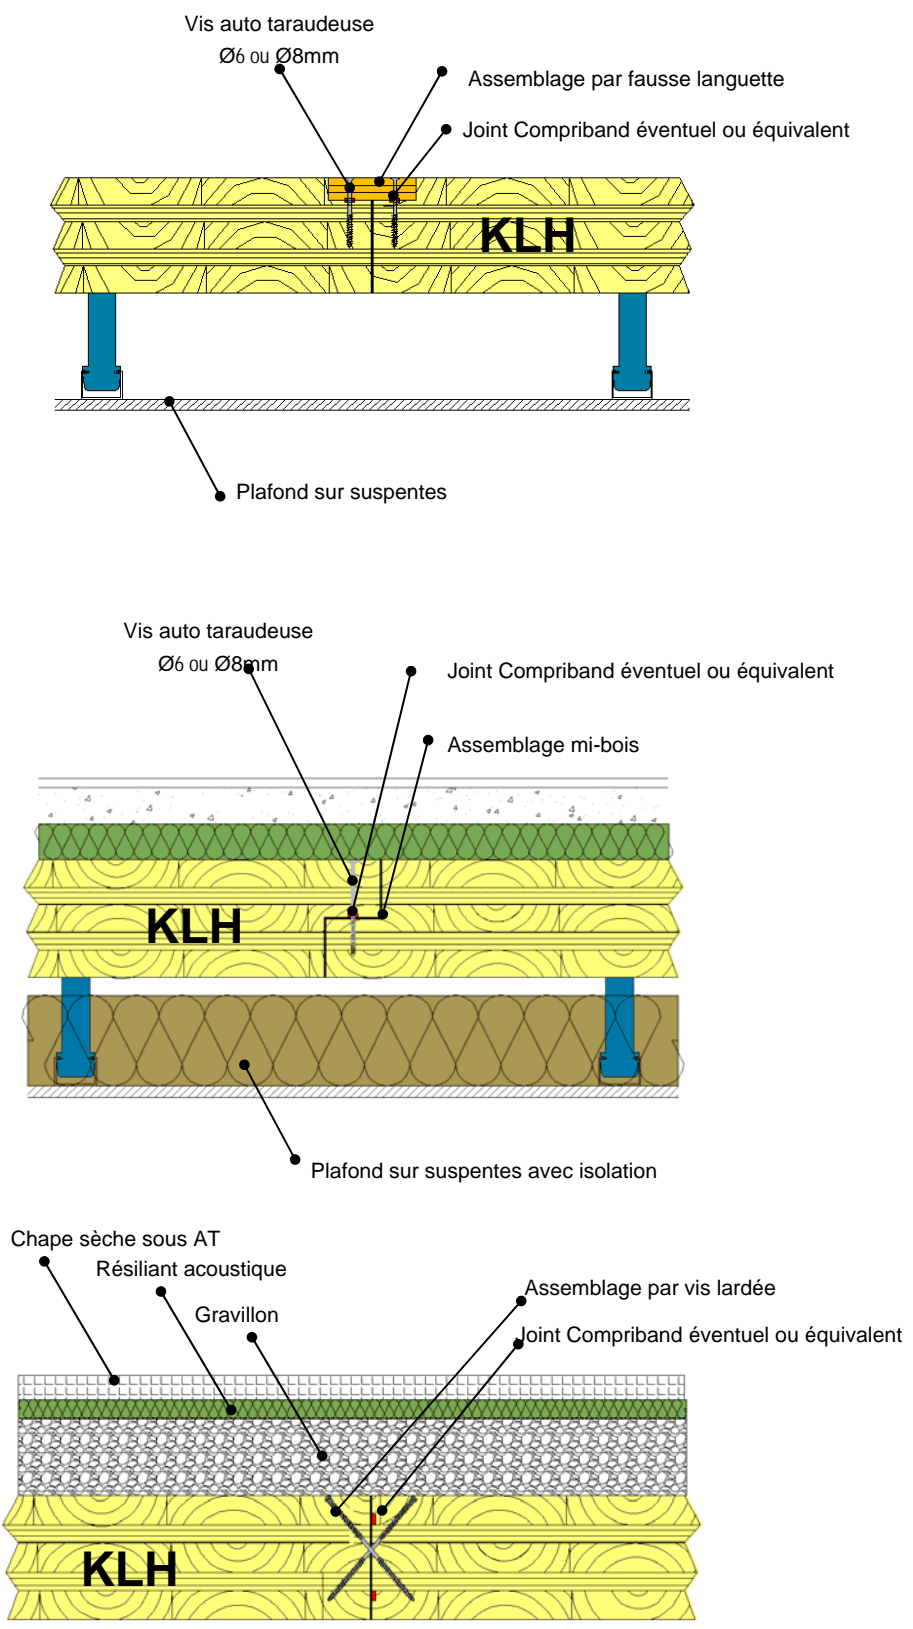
Coupe verticales jonction usuelles de planchers ou de murs
